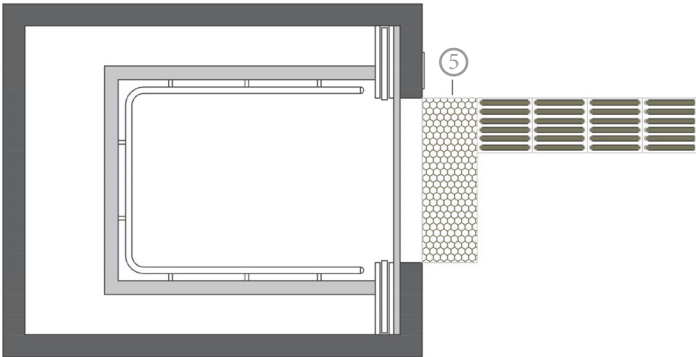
3 Franja de advertencia táctil para elevador - Planta
